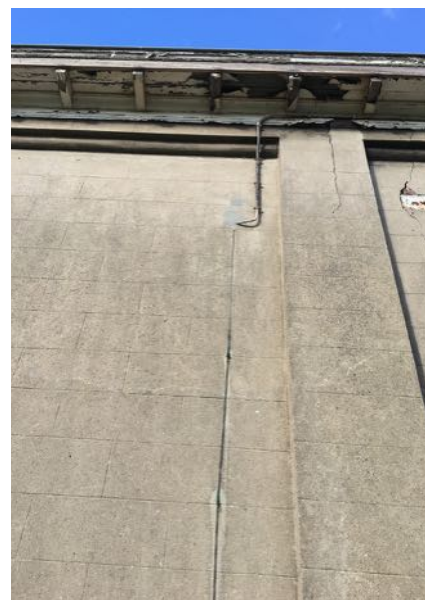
Zicht gecementeerde tandlijst onder dakgoot
